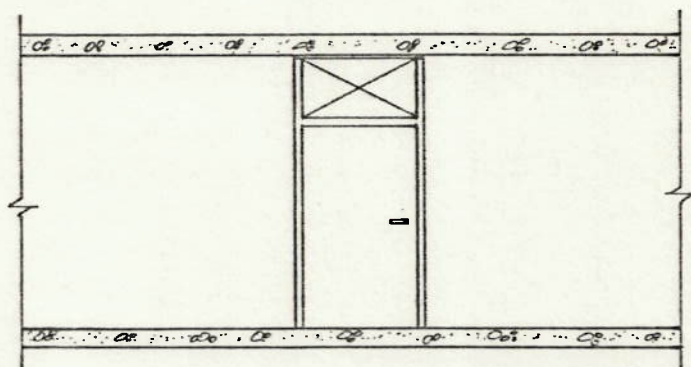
Seccionamento das paredes do último pavimento, empregando-se portas com bandeira
